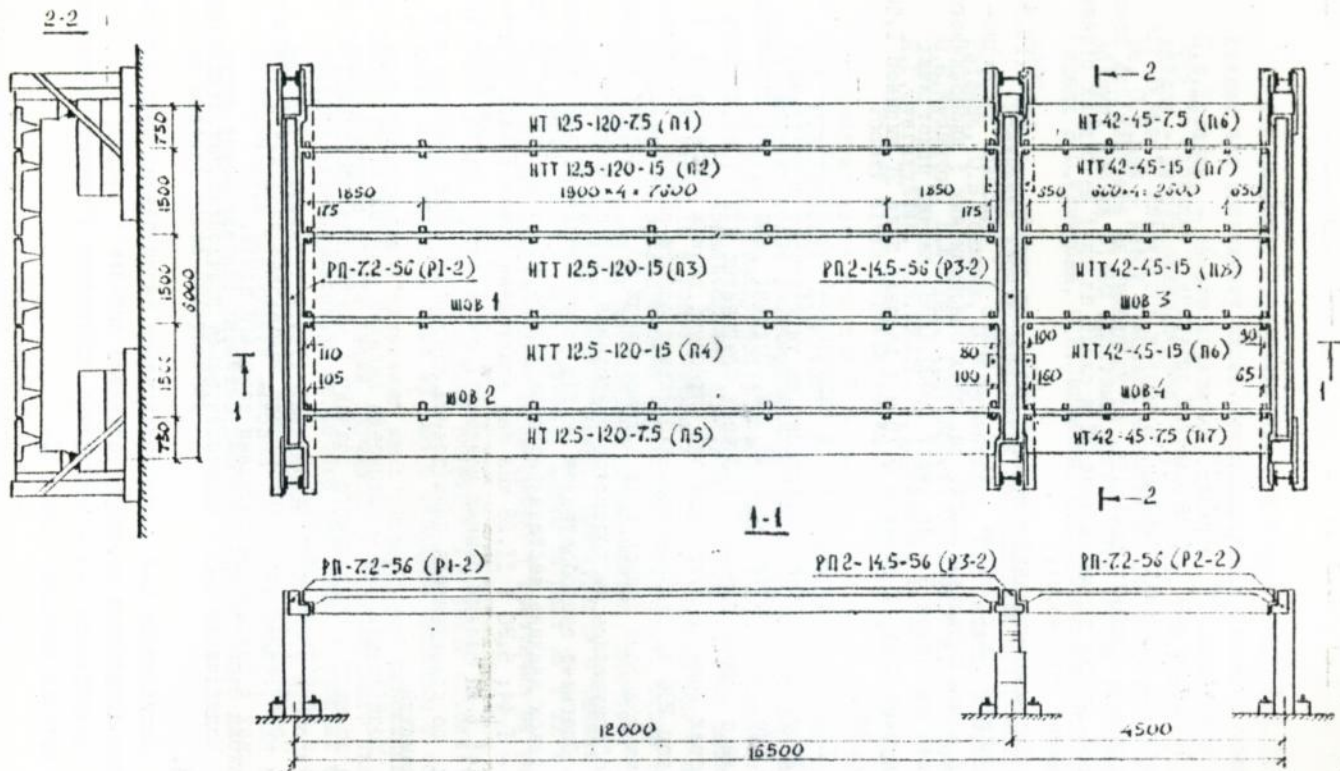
Схема монтажных элементов фрагмента перекрытия 16.5 x 6 м.
